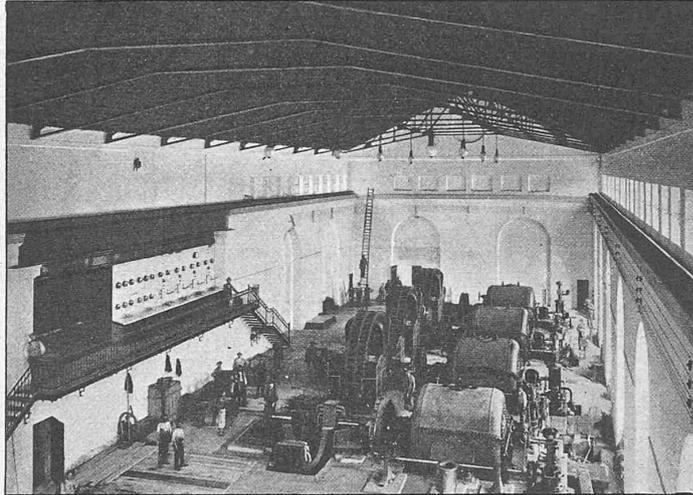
Ansicht des Maschinensaals in Paderno während der Montage.
